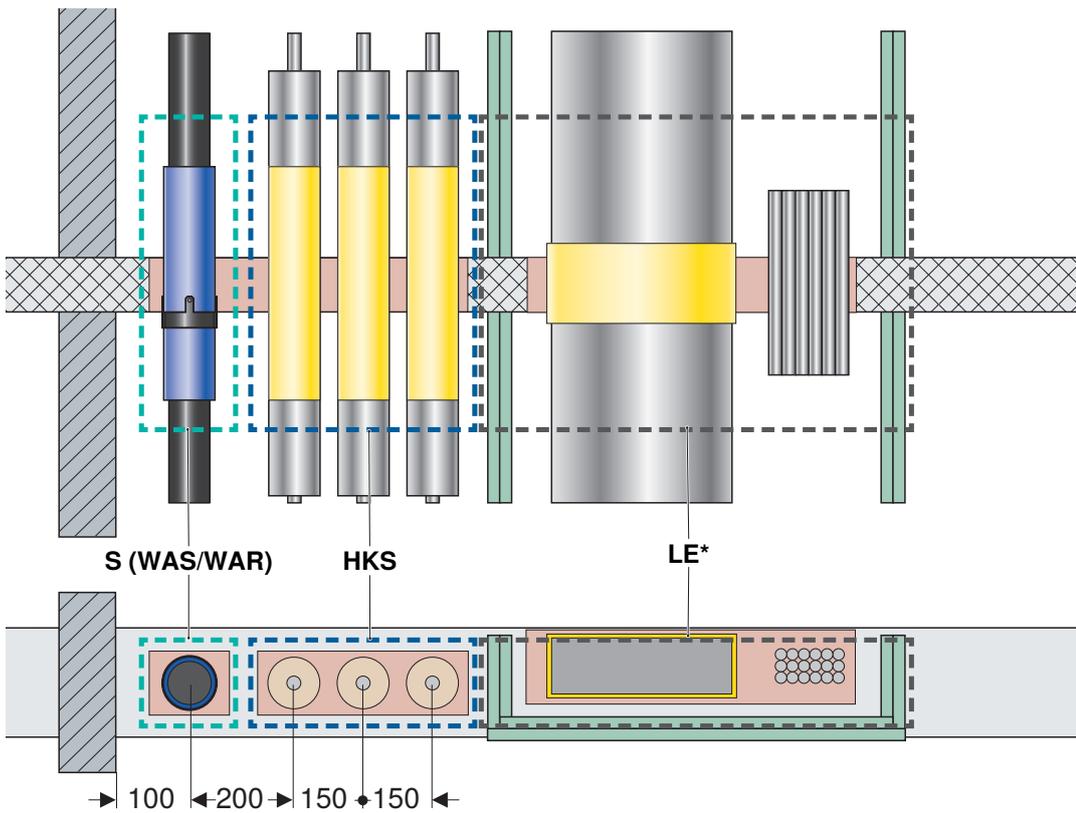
Steigzone für alle Gebäudearten und Bauhöhen, mit Verwendung der Geberit Brandschutzmanschette, mit Schachtinstallation
